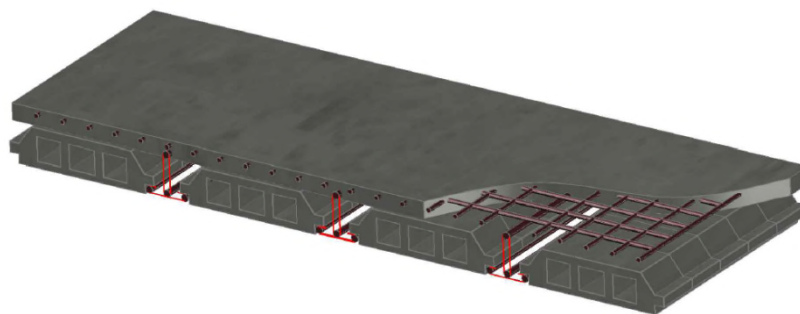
Illustration en 3D d'un plancher à entrevous.
